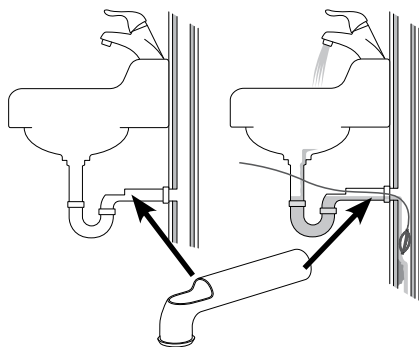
Installazione del tubo a parete (accessorio disponibile)
